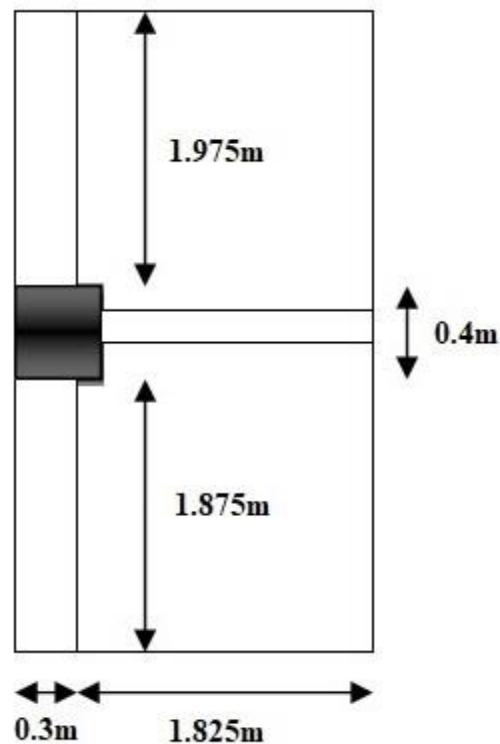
Poteau de rive (RDC, 1<sup>er</sup> et 2<sup>eme</sup> étage).
